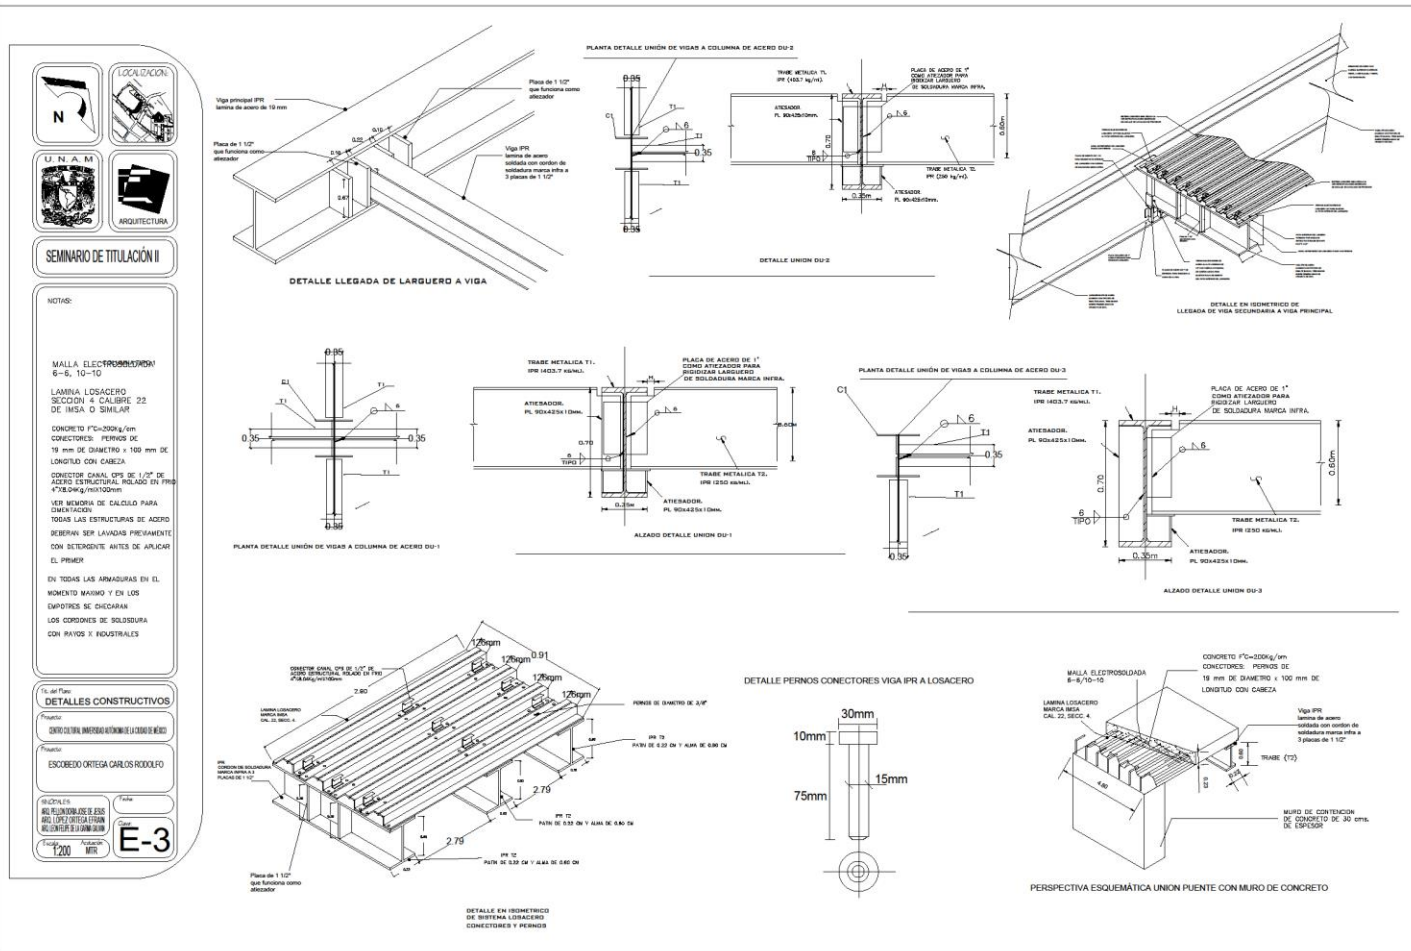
Detalles Estructurales del Centro cultural UACM plantel Cuatepec. Creación propia.
